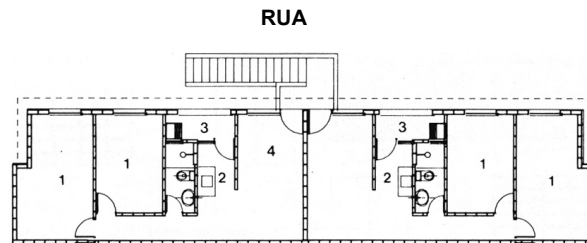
Planta tipo do projeto Paranapanema (VB-05).
